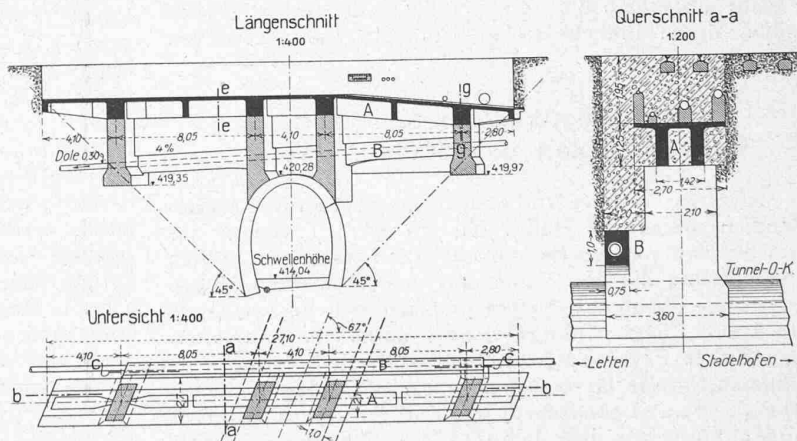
Grundriss, Längs- und Querschnitt der Tunnel-Überbrückung.
